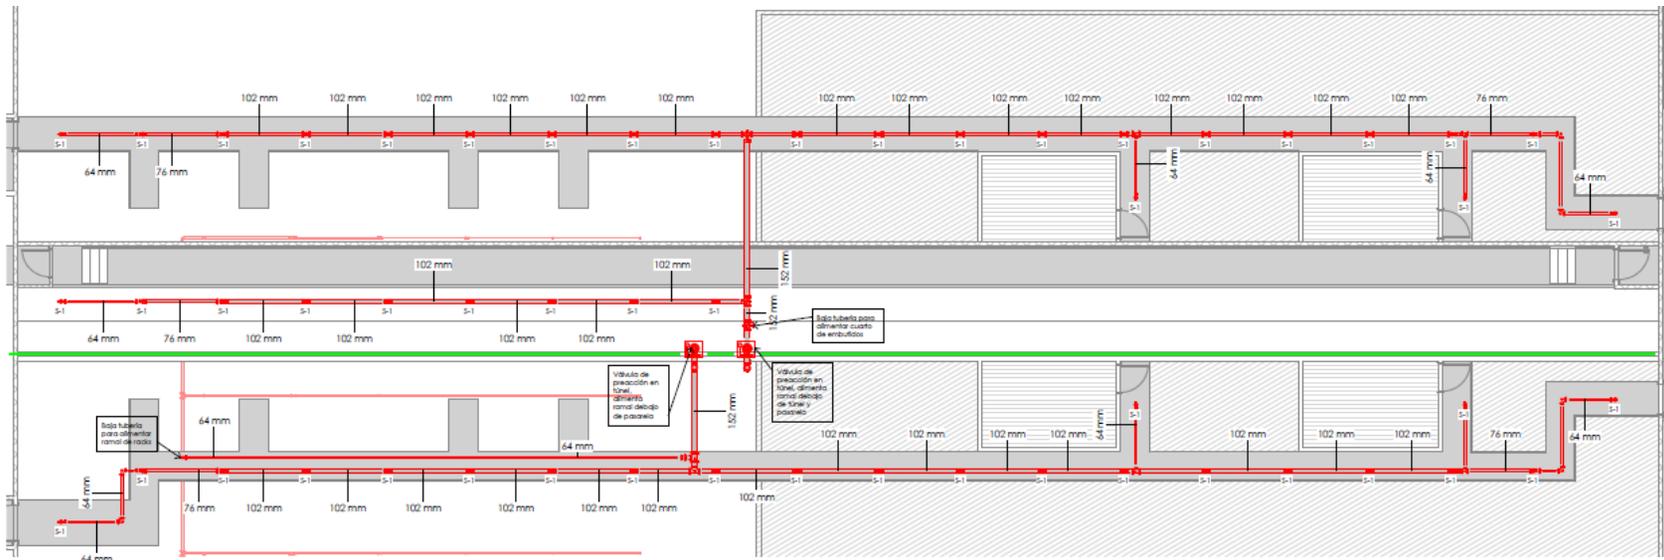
Sección del plano "Planta de supresión de incendios-Refrigerado & Docks bajo pasarelas"
